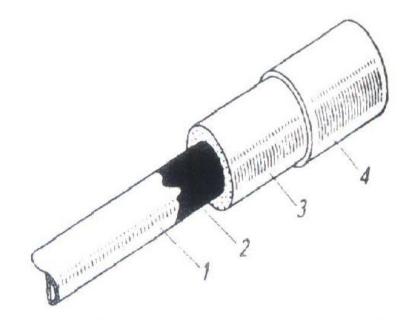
Теплоизоляционная конструкция с битумоперлитной изоляцией 1 – труба; 2 – антикоррозионное покрытие; 3 – битумоперлит; 4 – гидрозащитное покрытие из стеклоткани по лаку
